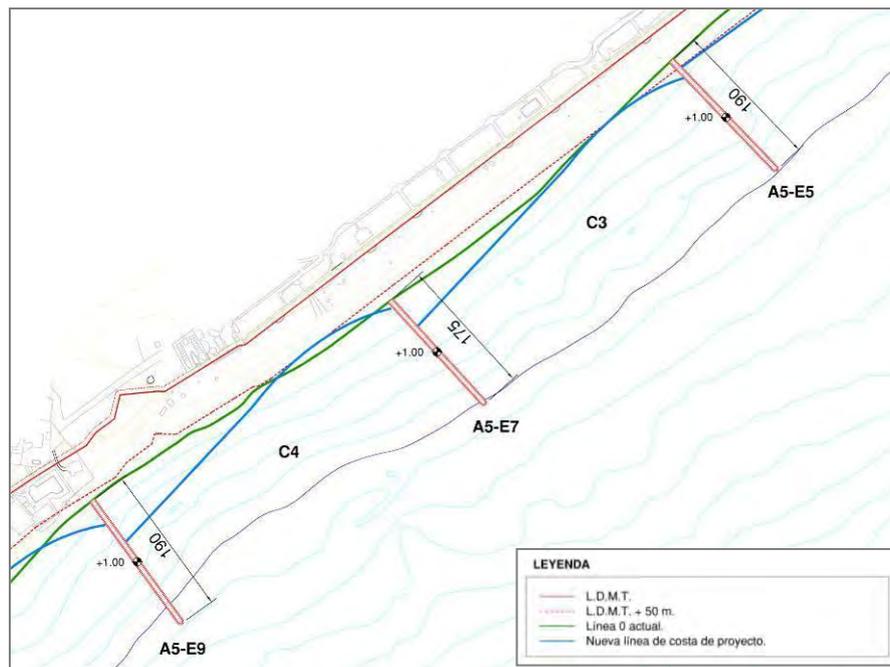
Planta Alternativa 5. Celdas C3-C4.
